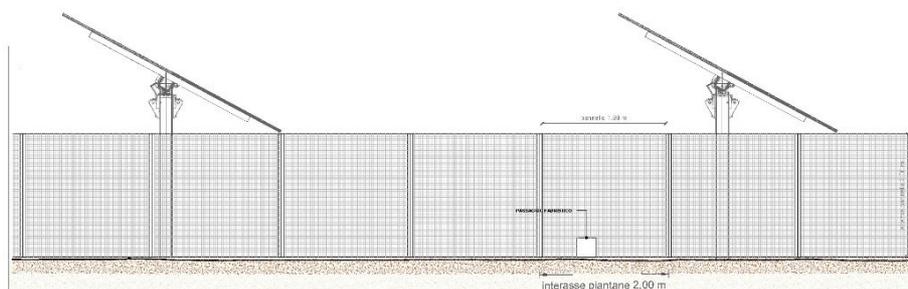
Prospetto recinzione perimetrale senza mitigazione
